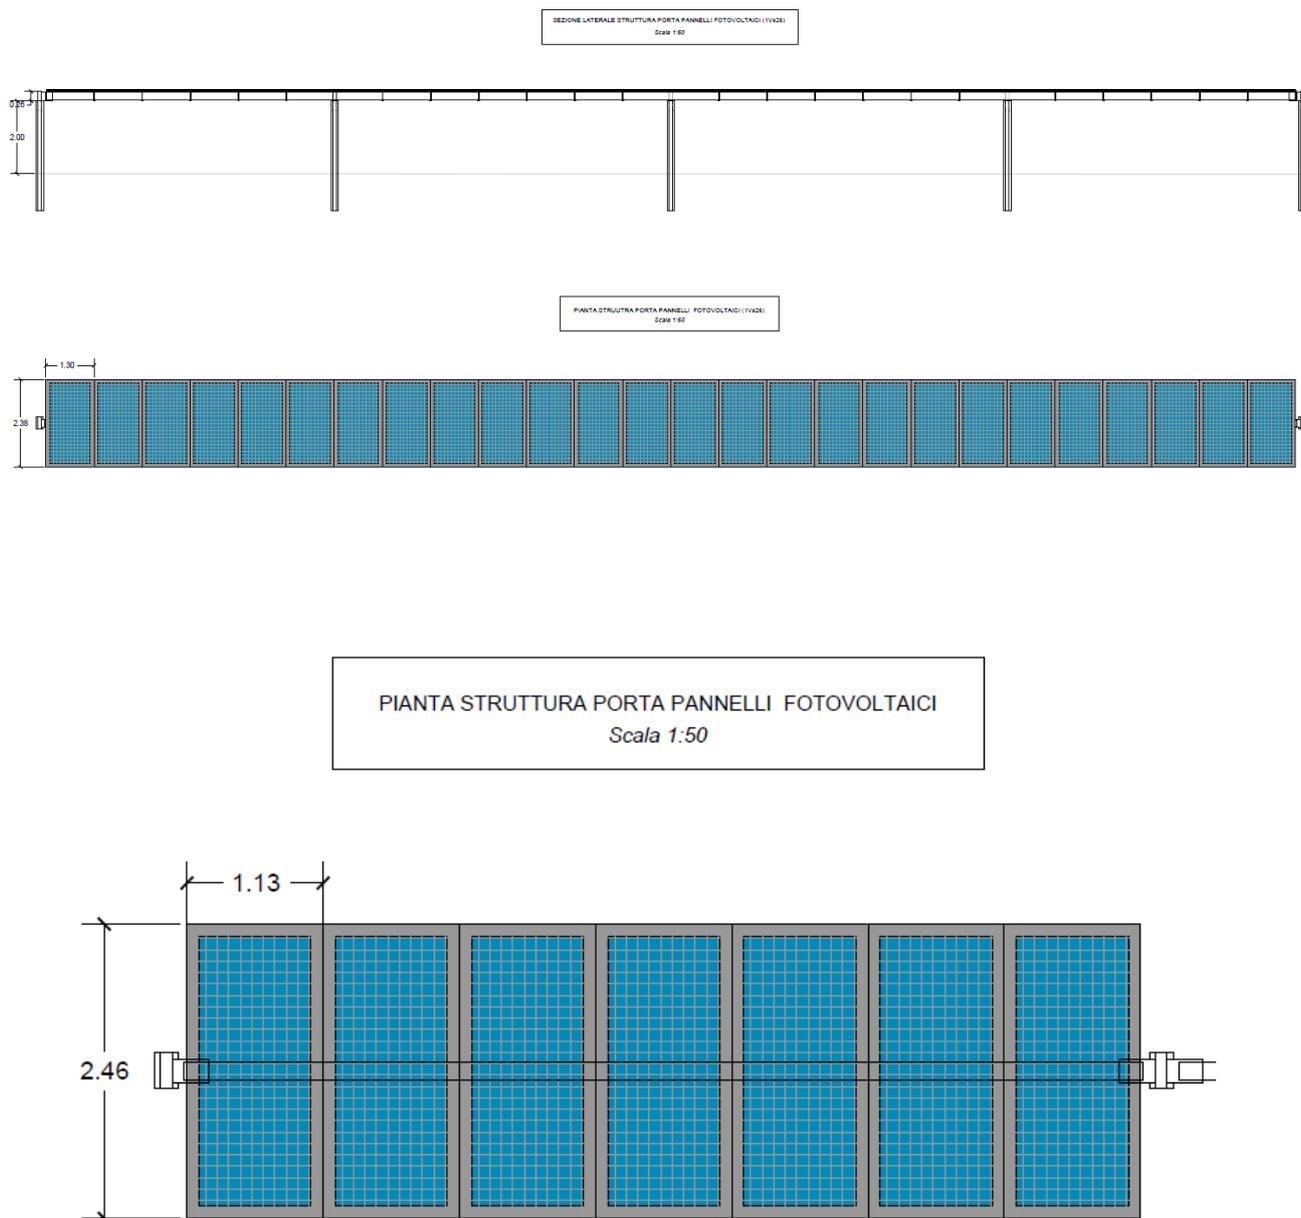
Schema della struttura – vista longitudinale e pianta 1x26
